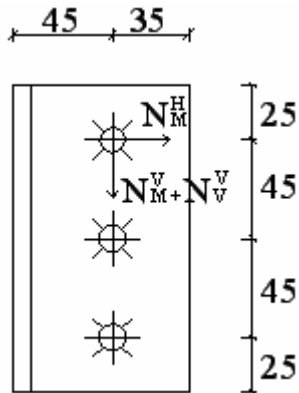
Ana Kiriş – Döşeme Kirişi Birleşimi
